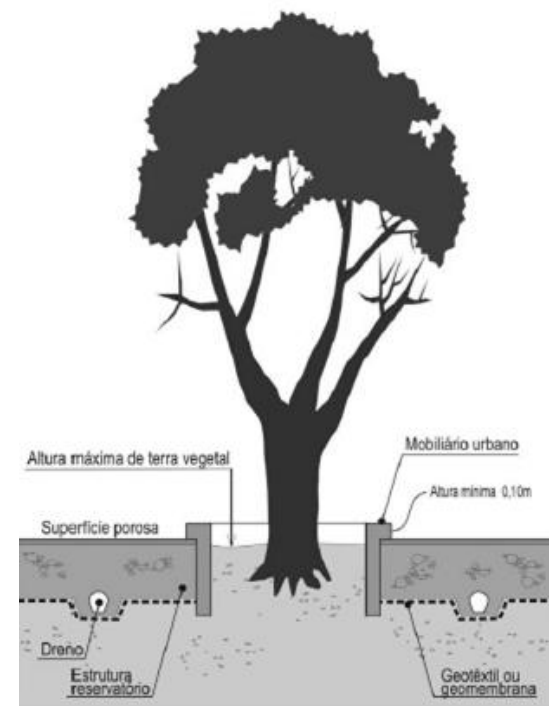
Corte transversal do pavimento reservatório aplicável a espaço verde. Fonte: MATOS, R. (2008) Gestão integrada de sistema de saneamento: soluções de controlo na origem de águas pluviais
